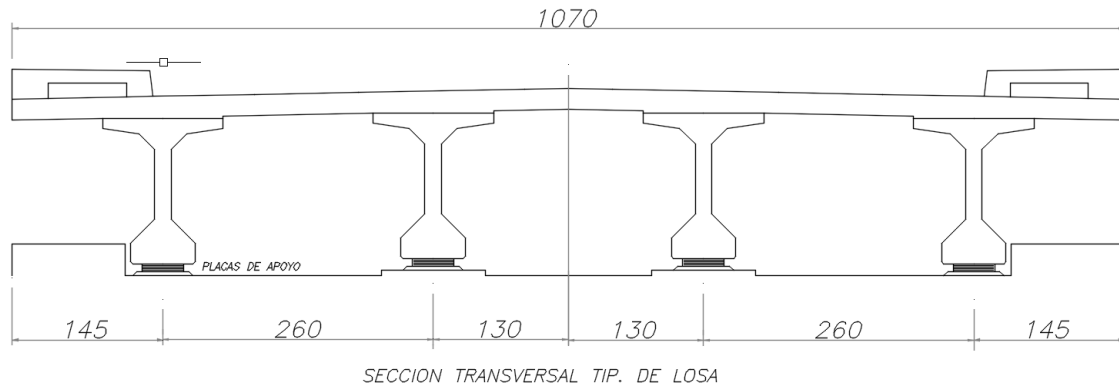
Sección transversal tipo de la losa, distancias en centímetros. Fuente: Plano de Construcción Losa Águila Norte.
